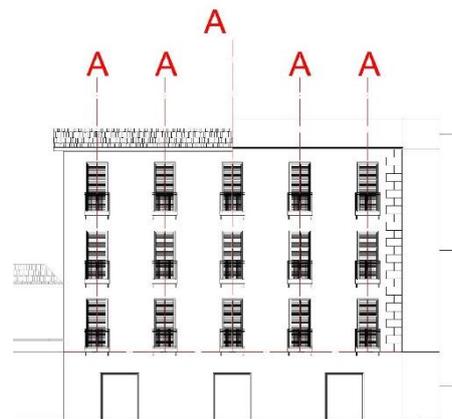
Façade d'immeuble collectif fait par les auteurs
